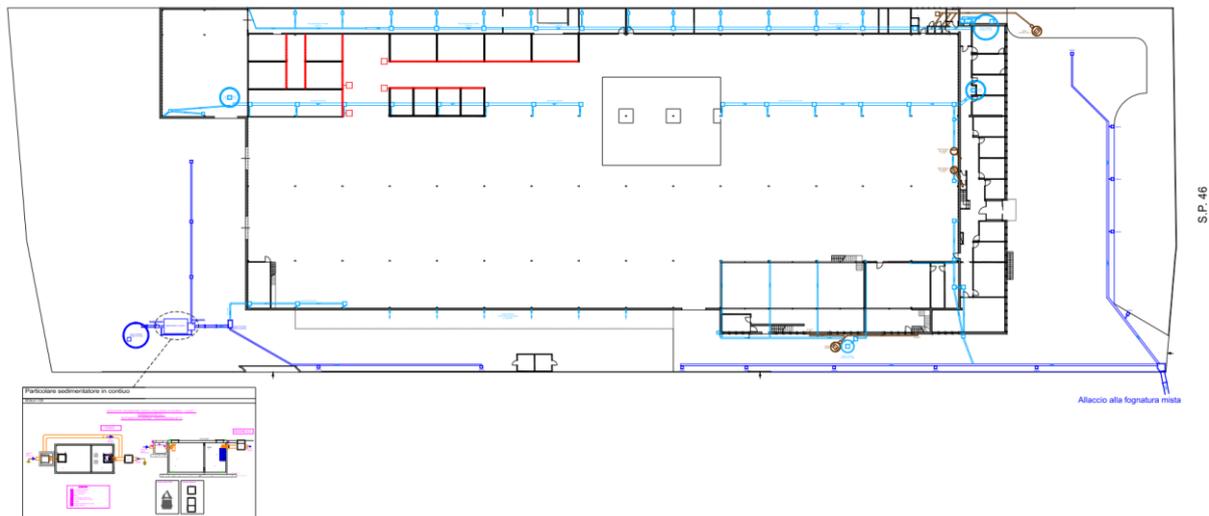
PLANIMETRIA DEGLI SCARICHI DELLE ACQUE.
